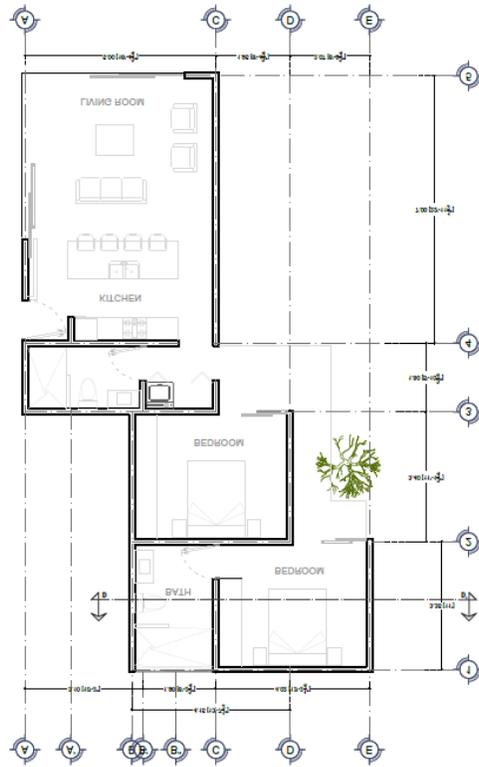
Planta arquitectónica del departamento tipo del Edificio 4.
